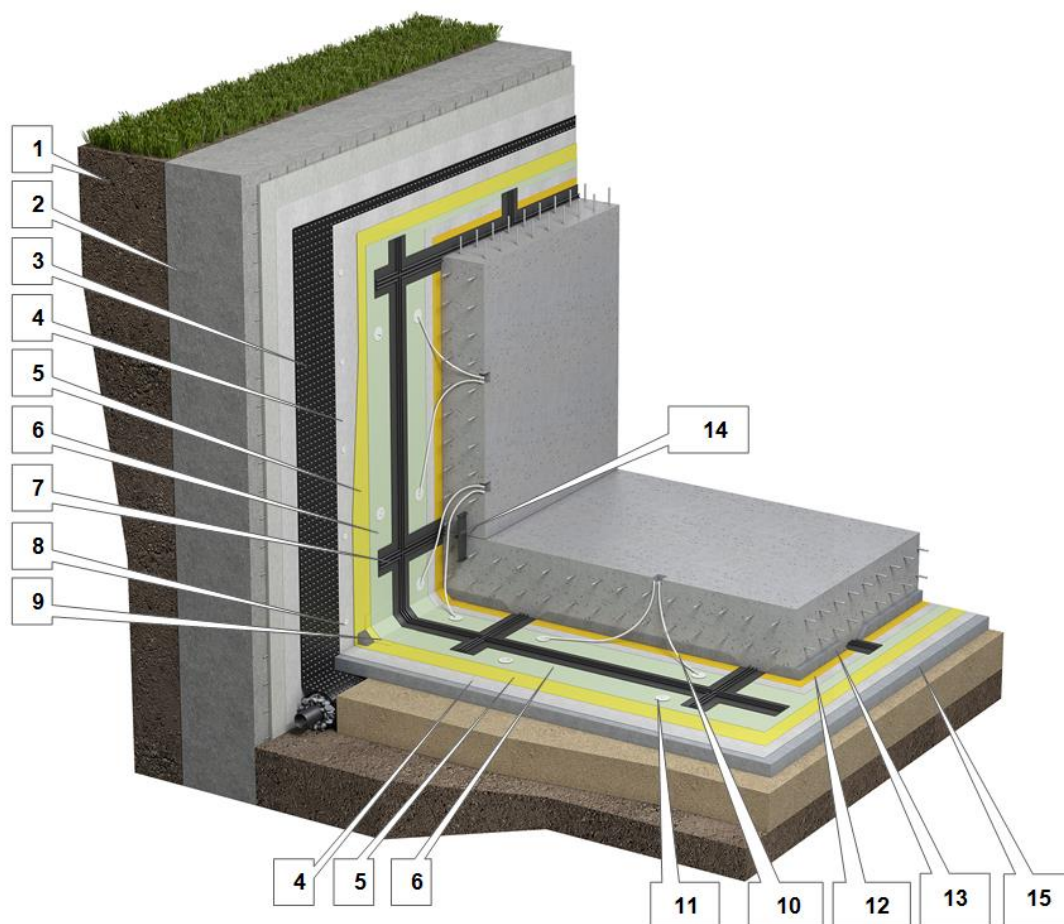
Конструкция двухслойного гидроизоляционного покрытия транспортных тоннелей открытого способа производства работ при примыкании несущей конструкции тоннеля (обделки) непосредственно к ограждающей конструкции котлована. Без доступа к наружным поверхностям ограждающих стеновых конструкций.
